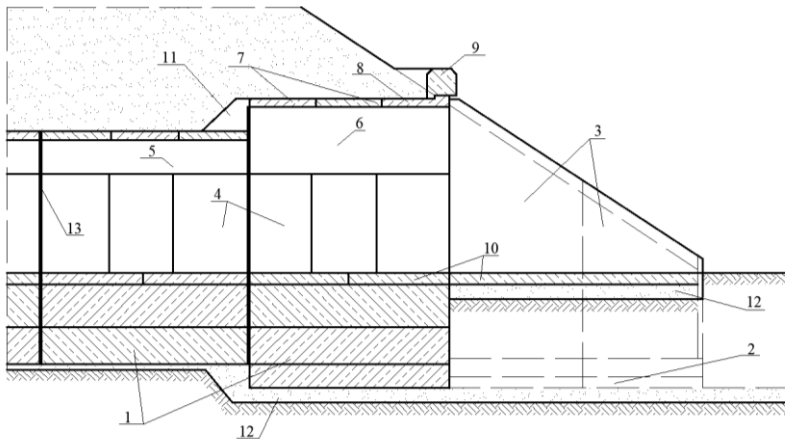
Оголовок прямоугольной бетонной трубы с повышенным звеном:
